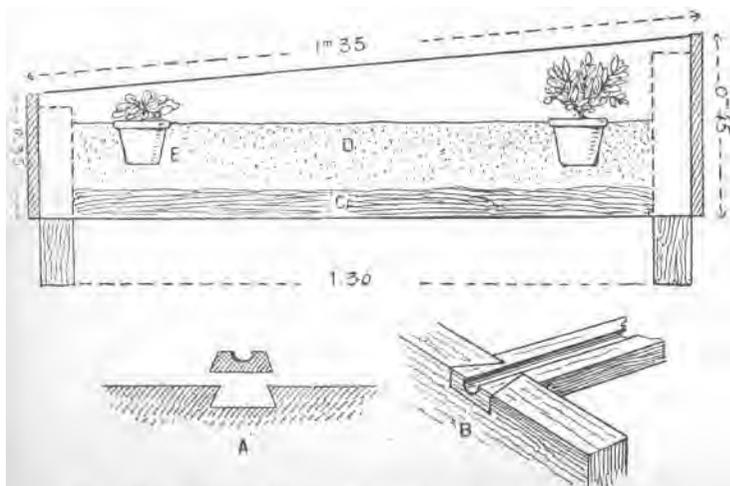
Bâche mobile vue en coupe avec détails de construction.
